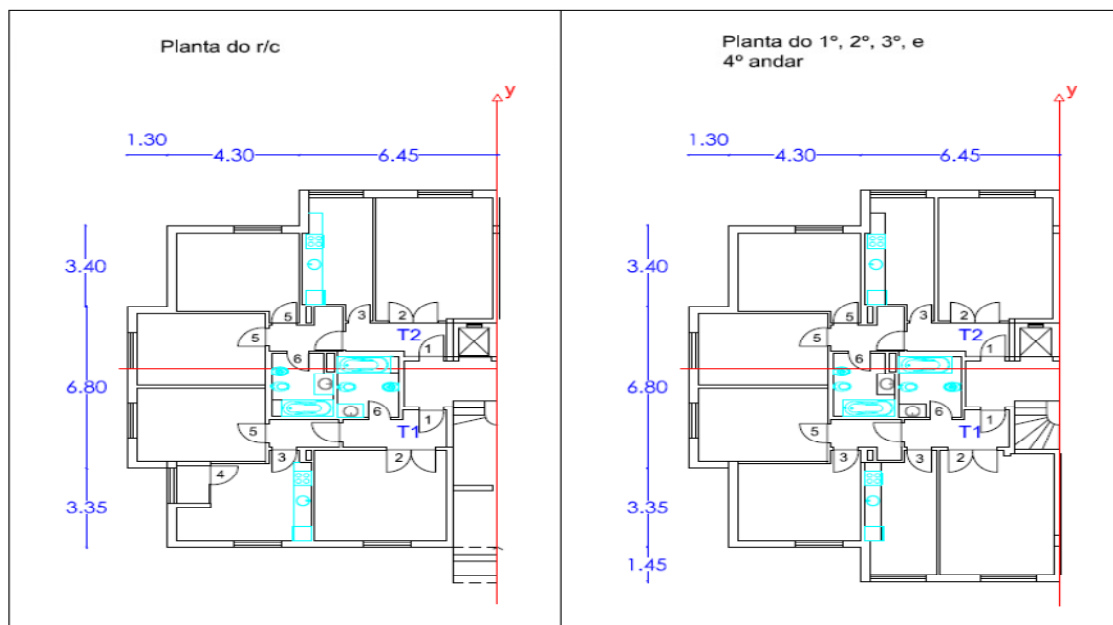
Geometria em Planta Piso R/C e Piso dos Andares
